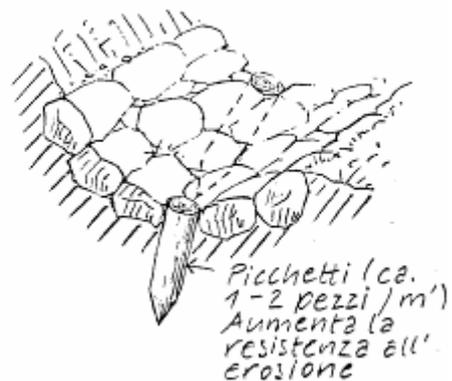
tipologico di fondo alveo in pietra, particolare 2
